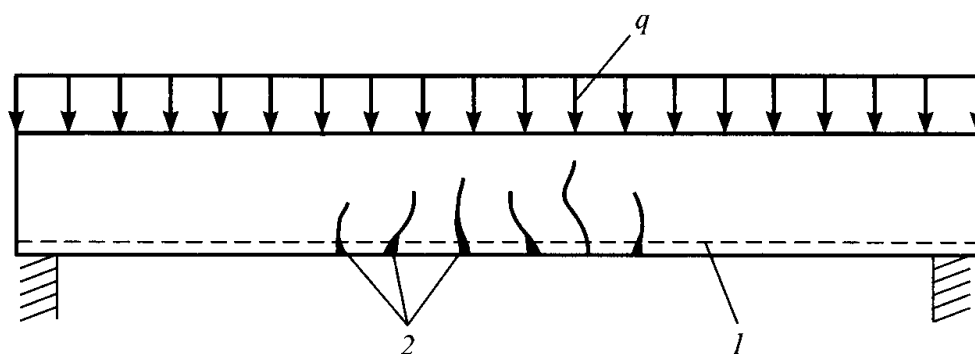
Оценка повреждений железобетонных конструкций по кратковременному образованию и раскрытию нормальных трещин:
